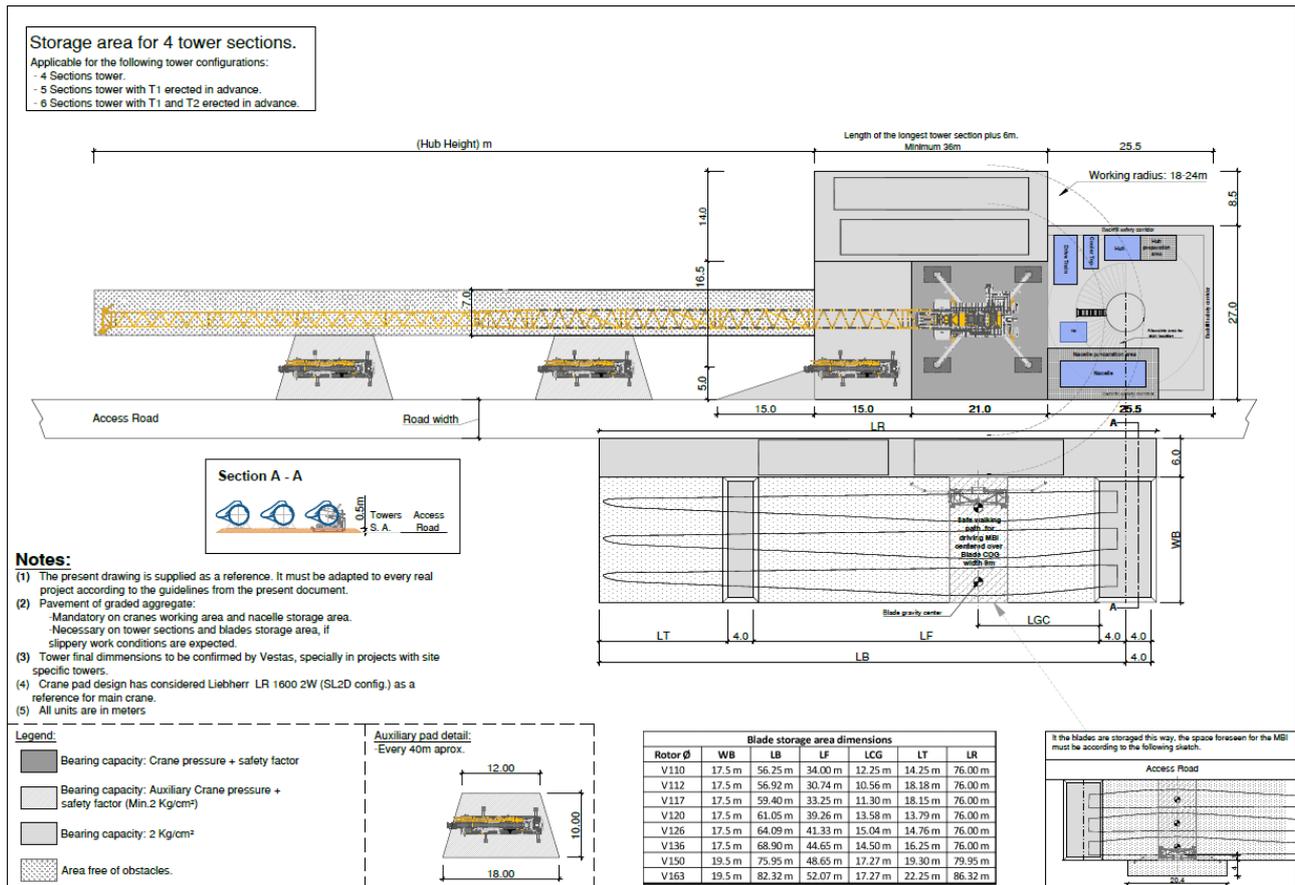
Schema layout di cantiere - piazzola aerogeneratore – Fonte: Vestas
